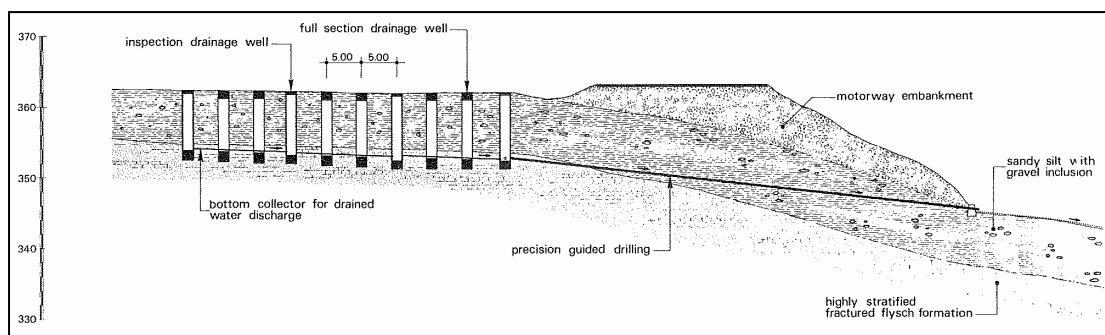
Utilizzo di pozzi verticali drenanti lungo il tratto autostradale Firenze – Bologna (da COLLOTTA et al., 1988) -
